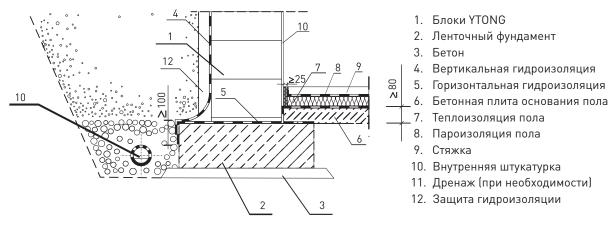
Опирание подвальных стен на ленточный фундамент
